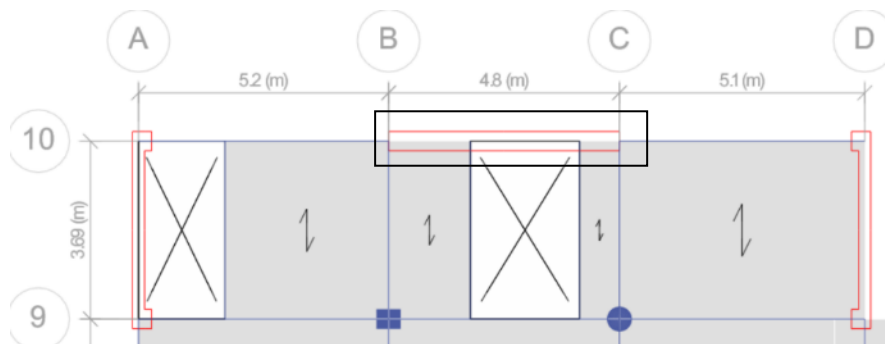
Ubicación del Muro Estructural, Fuente: elaboración propia en Etabs
